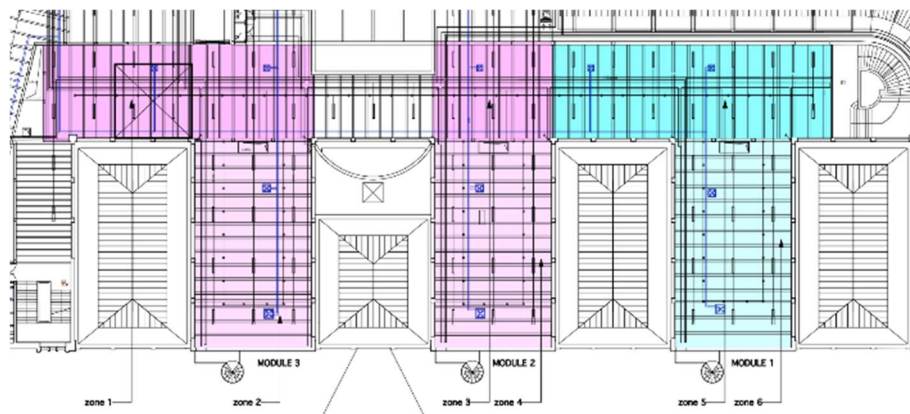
Extrait Plan DOE Niveau 2 - Hugues FONTENAS Architectes (2010)
